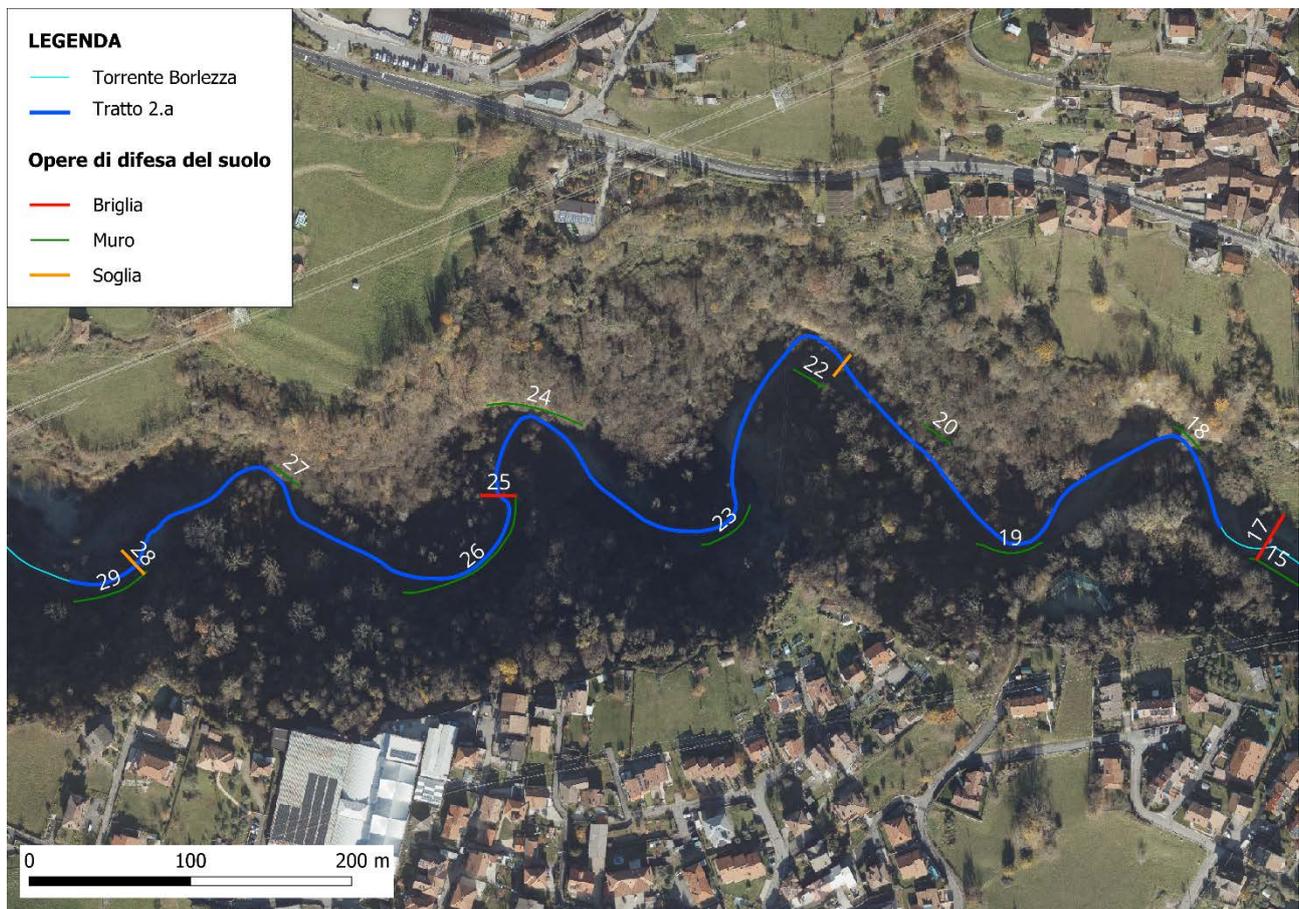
ESTRATTO PLANIMETRICO TRATTO 2.A
